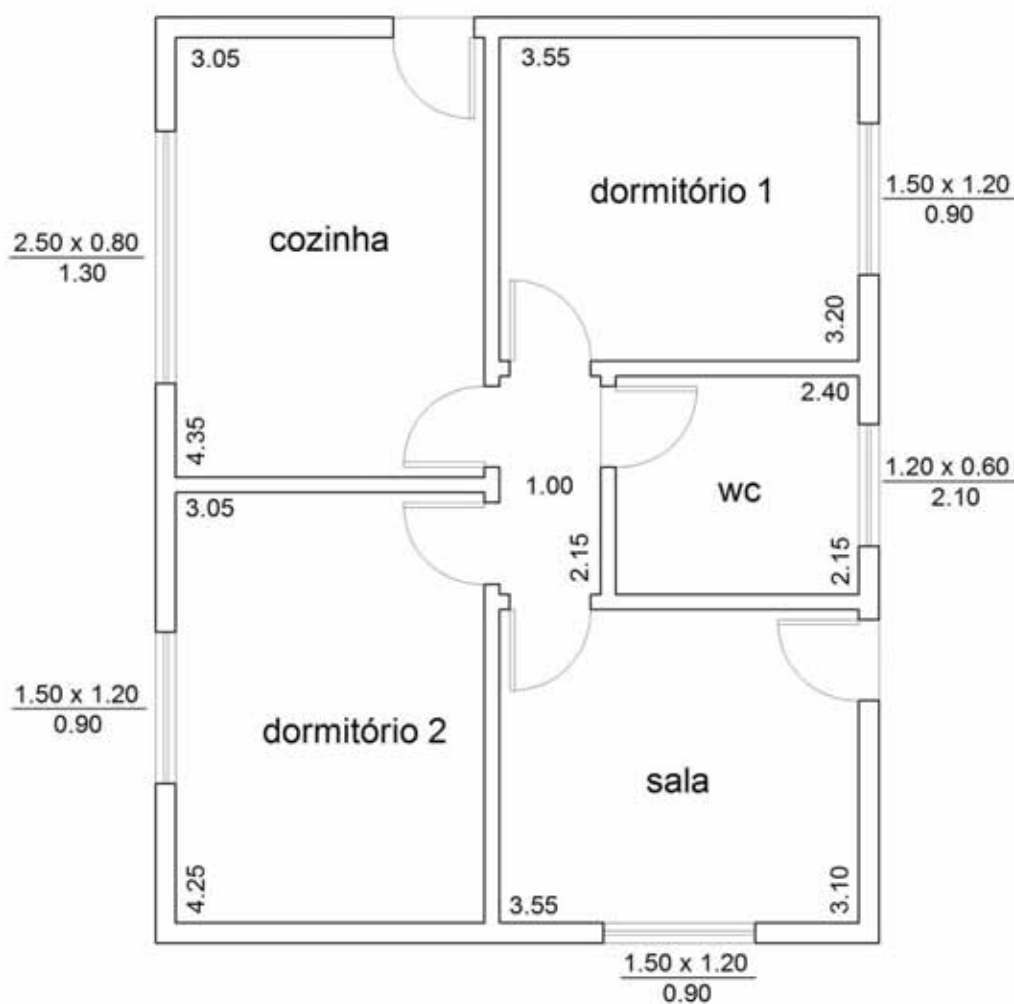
Planta baixa adotada no estudo de caso (fonte: do autor)
